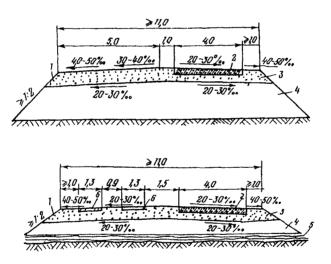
Поперечные профили двухполосных дорог с колейным деревянным и железобетонным (на грузовой полосе) покры — тием при строительстве трубопроводов диаметром более 1020 мм:
